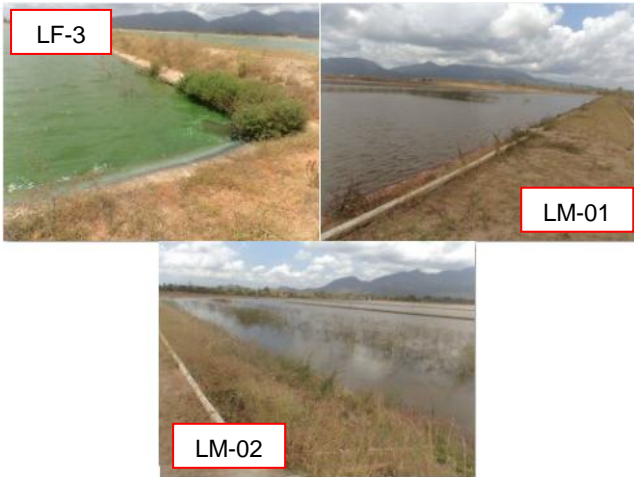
ETE Maranguape: lagoas com excesso de vegetação.
